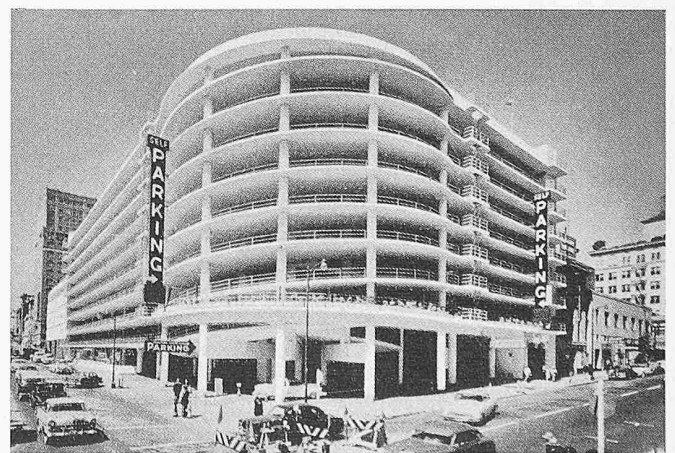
Ecke des Garagegebäudes mit Einfahrt und Aufstiegsrampe (unterster Teil der Abstiegsrampe im Erdgeschoss rechts der Bildmitte sichtbar).
